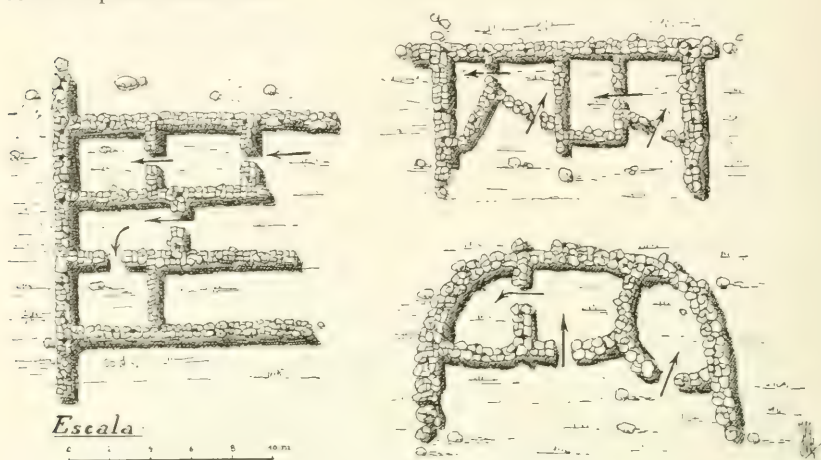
Ruinas de viviendas cuyos muros están apoyados contra las terrazas
